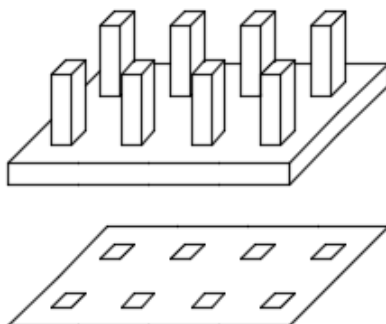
CIMENTACIONES FLOTANTES O LOSA DE CIMENTACIÓN.
